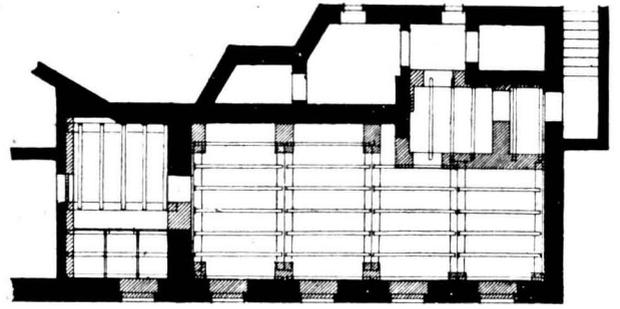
Grundriß des gleichen Luftschutzraumes mit den neuen Deckenkonstruktionen.
